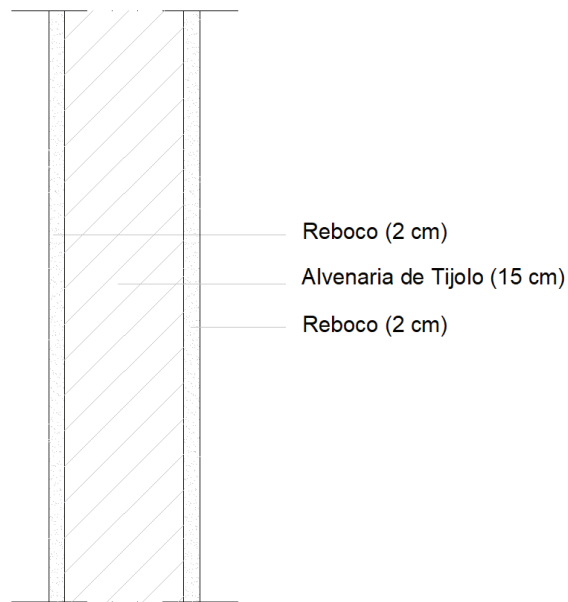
Pormenor construtivo da parede interior tipo VII (circulação)
